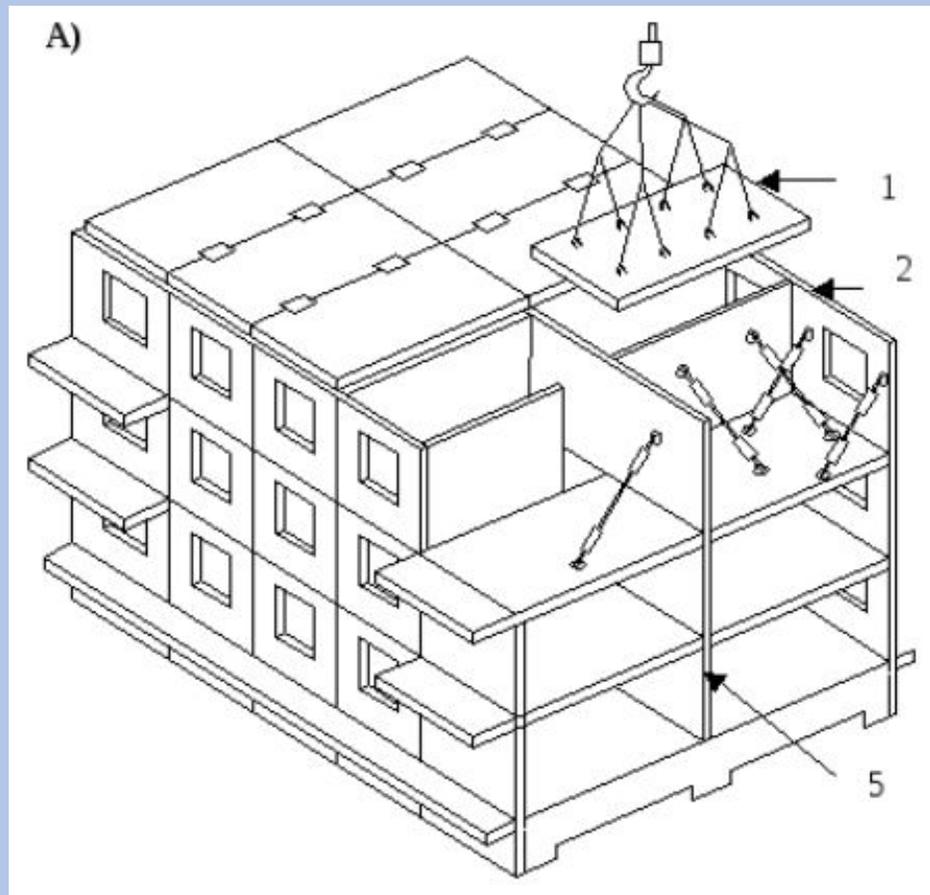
Здание с продольными и поперечными несущими стенами одновременно (опирание панелей перекрытия по контуру)
